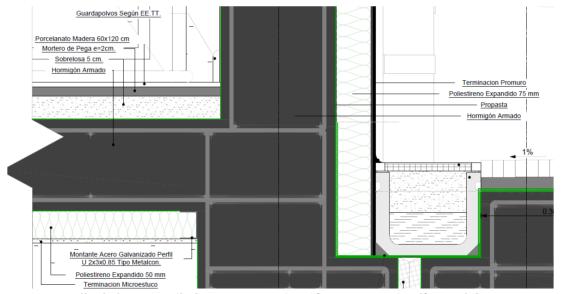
Detalle de base ventilada y muro terminación Promuro Fiscalía Local de Puerto Montt.
